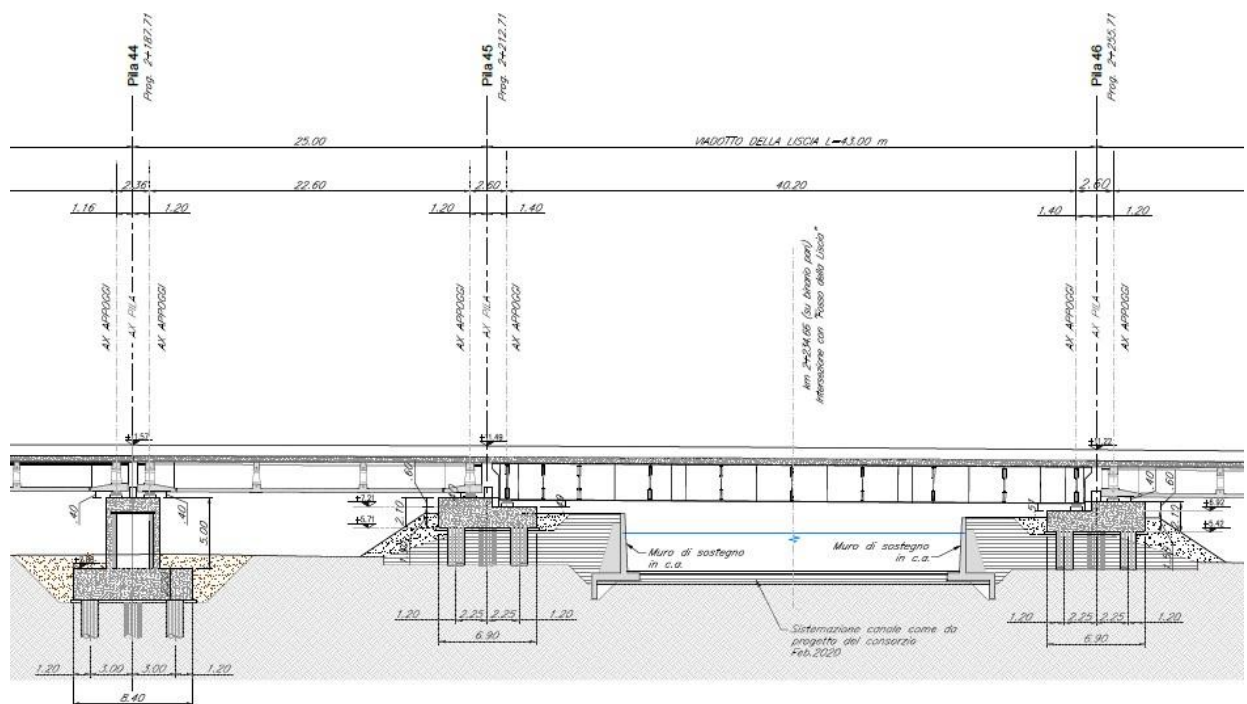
Sezione longitudinale stralcio viadotto Esino pile 44-45-46 - progetto esecutivo variante
